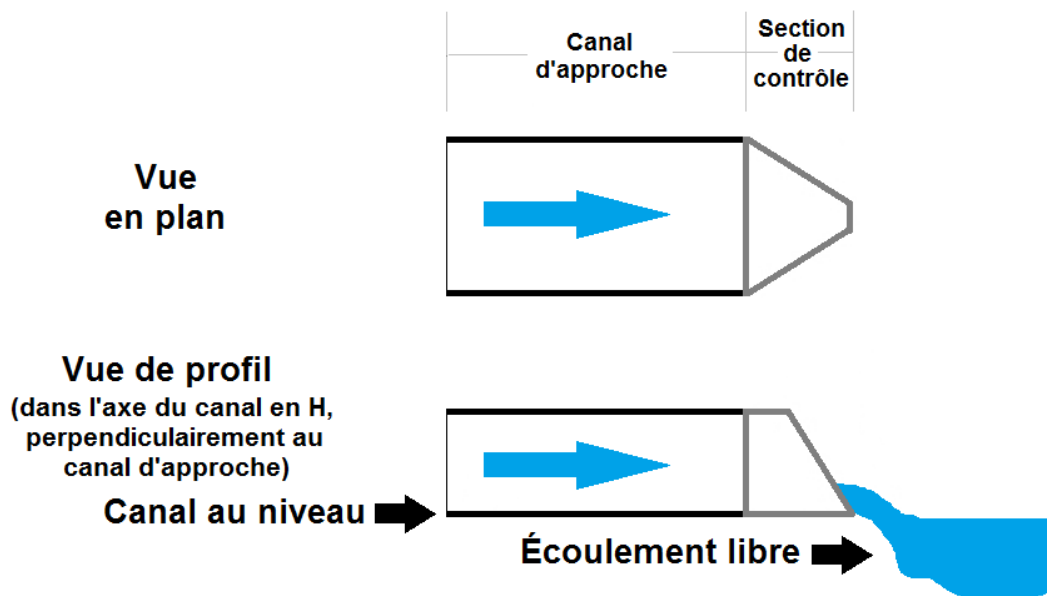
Vue en plan et de profil du canal d'approche, de la section de contrôle et de la sortie du canal en H
